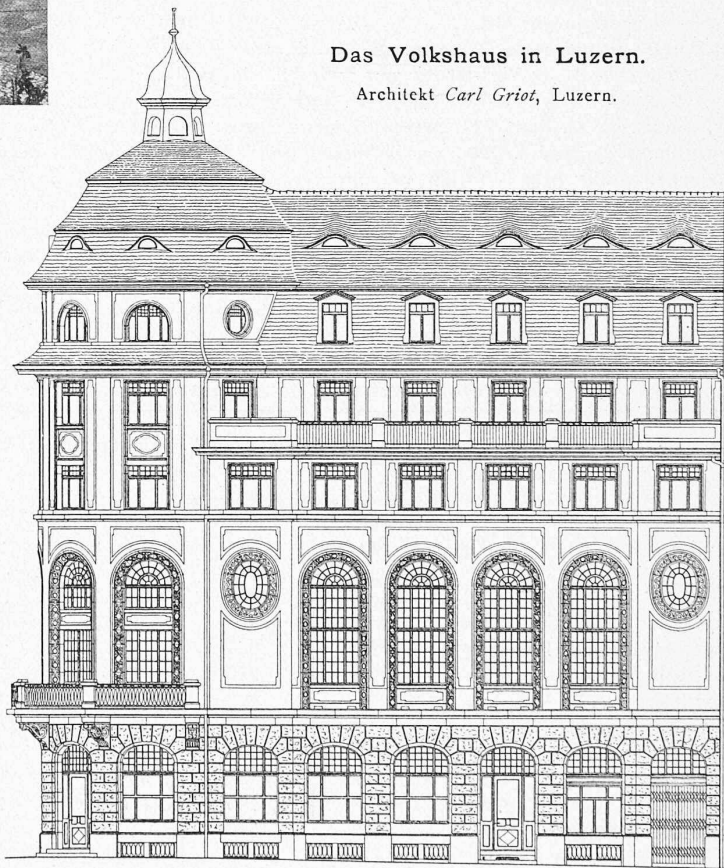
Fassade an der Pilatusstrasse. — Masstab 1:250.
